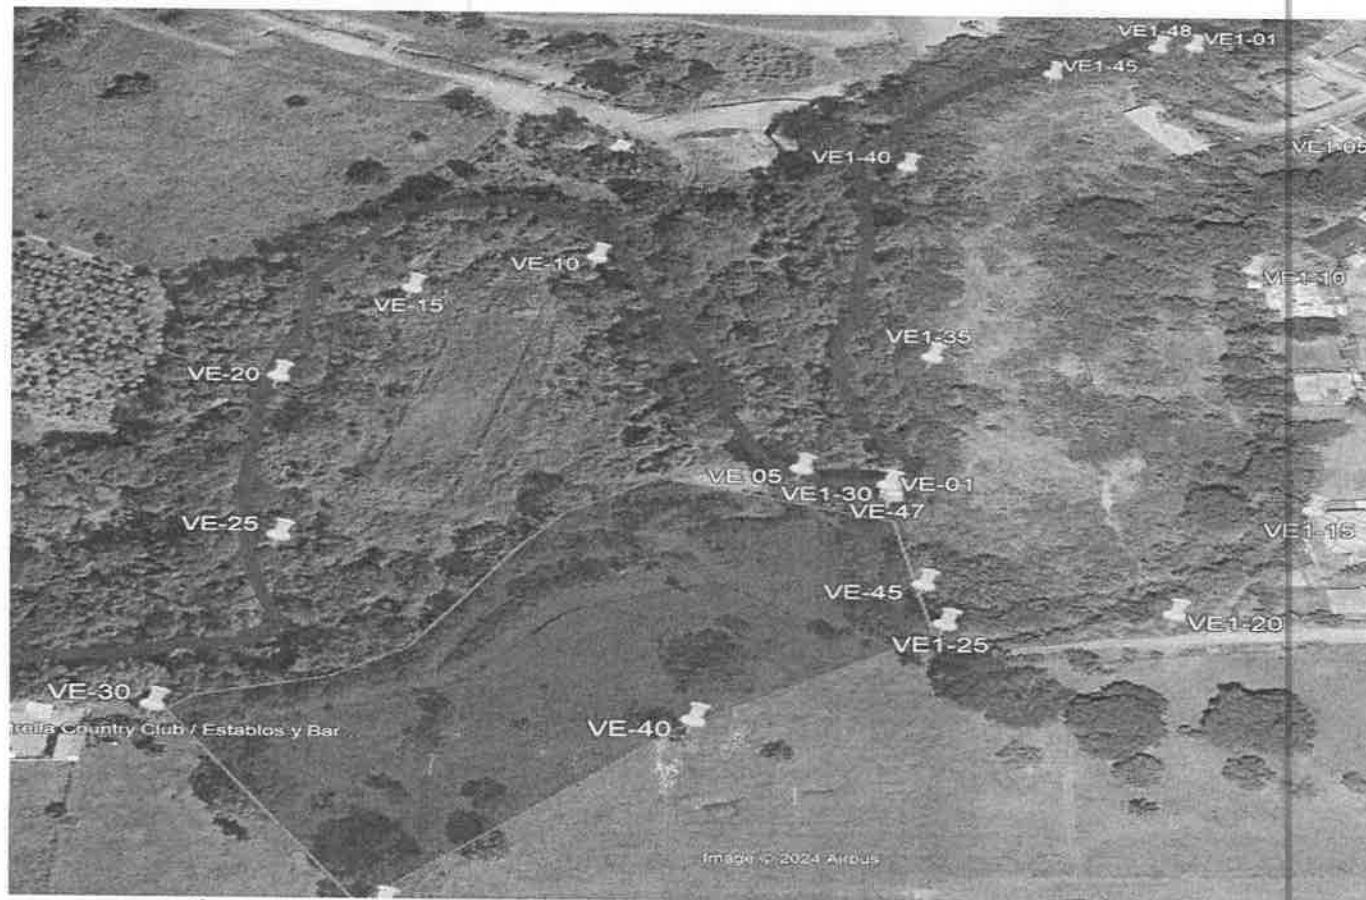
Área de corte y trabajos de terracería con banquetas (intervención aproximada de 2.2 hectáreas).
